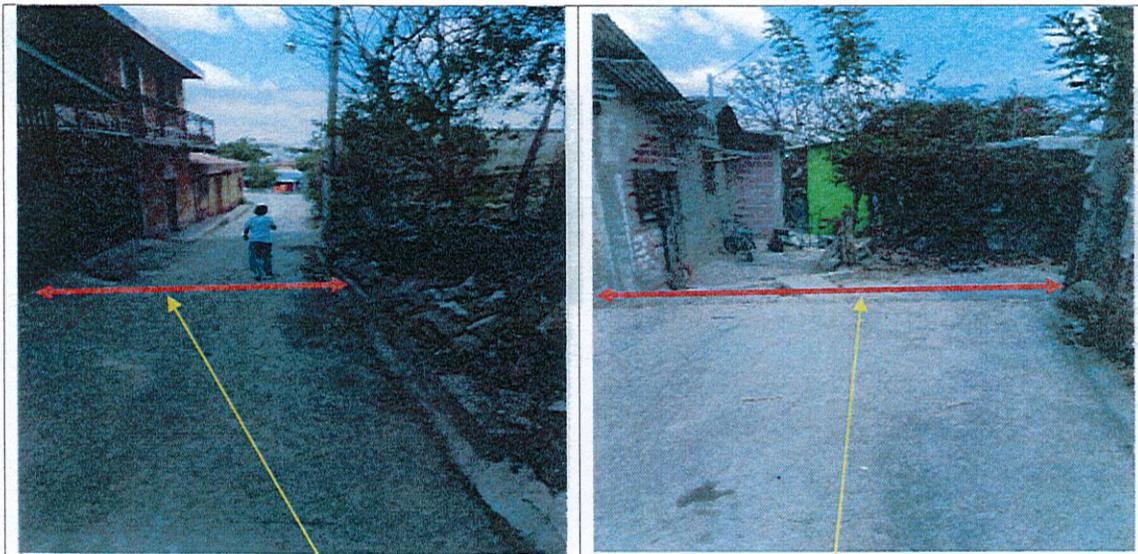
Y N°6: ANCHO DE CALLE EN TRAMO FINAL CON UNA DISTANCIA DE 4.55 METROS A 4.25 METROS.
